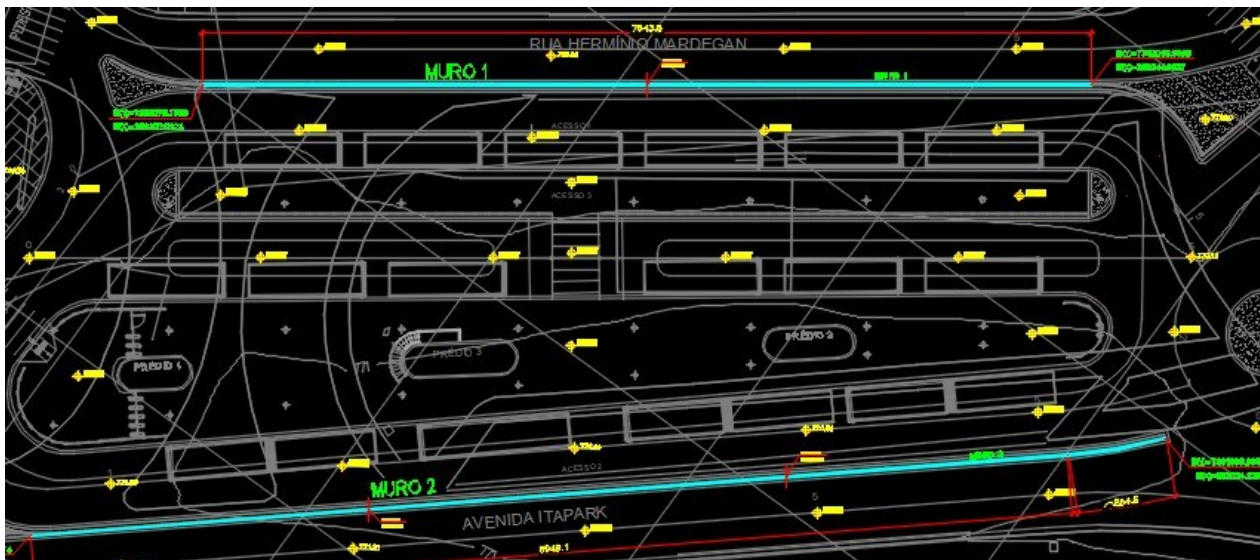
Planta com a localização e implantação geral dos Muros 1 e 2.
